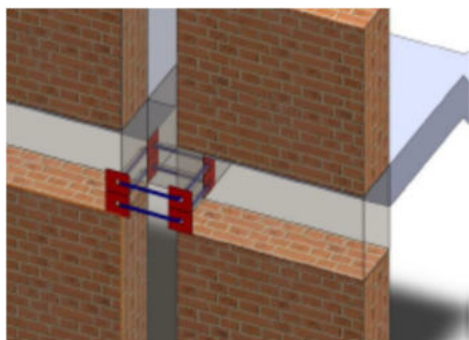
Particolare tipologico: Sistema CAM® applicata al nodo trave-pilastro in facciata.
